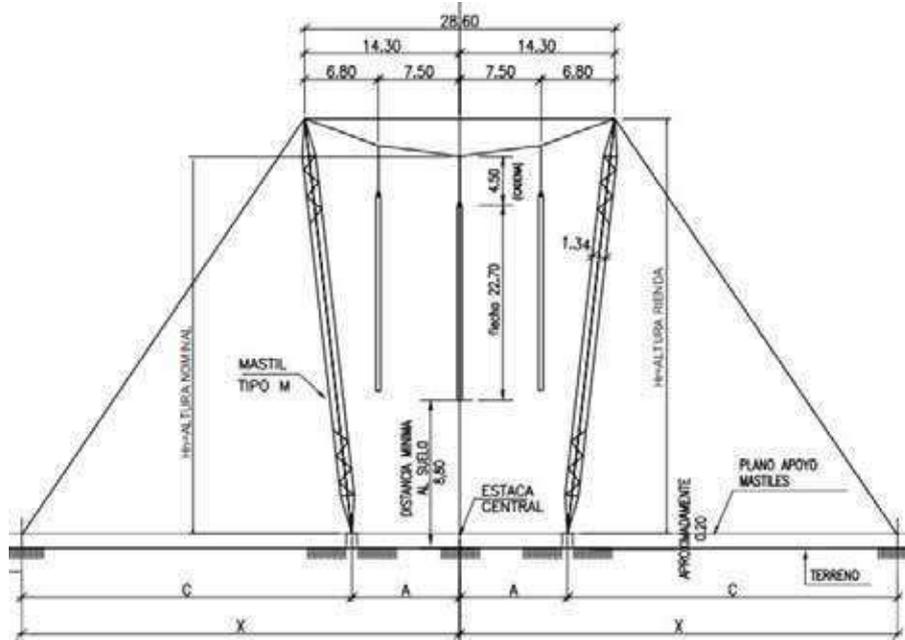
Plano de la Estructura de Suspensión Cross Rope
